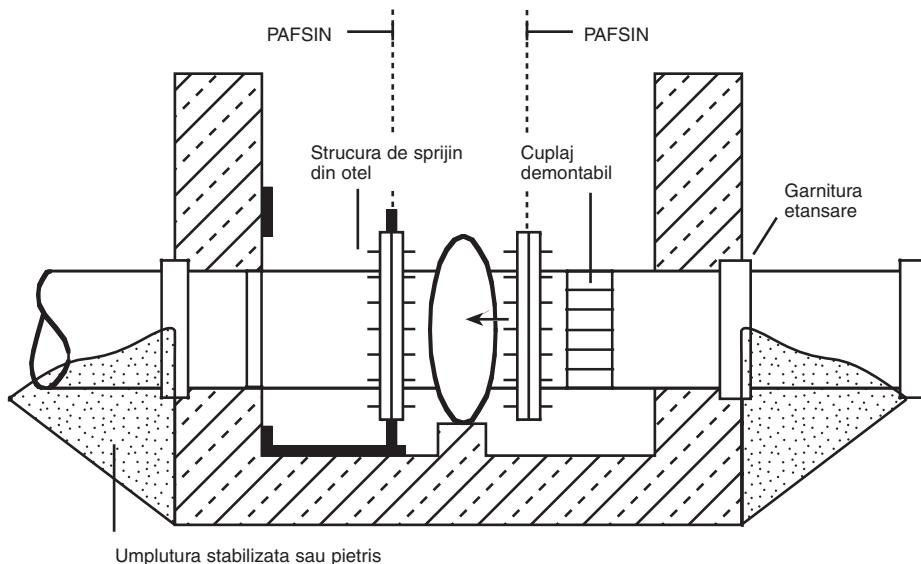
tipul III – utilizarea sistemului structural de sprijinire pentru a rezista fortelor de presiune
